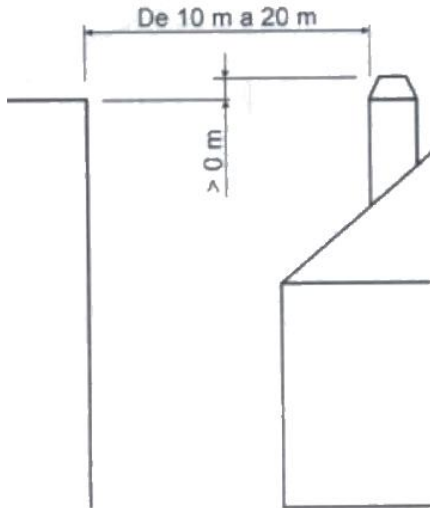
Distanza tra la finitura e oggetti tra 10 e 20 m
